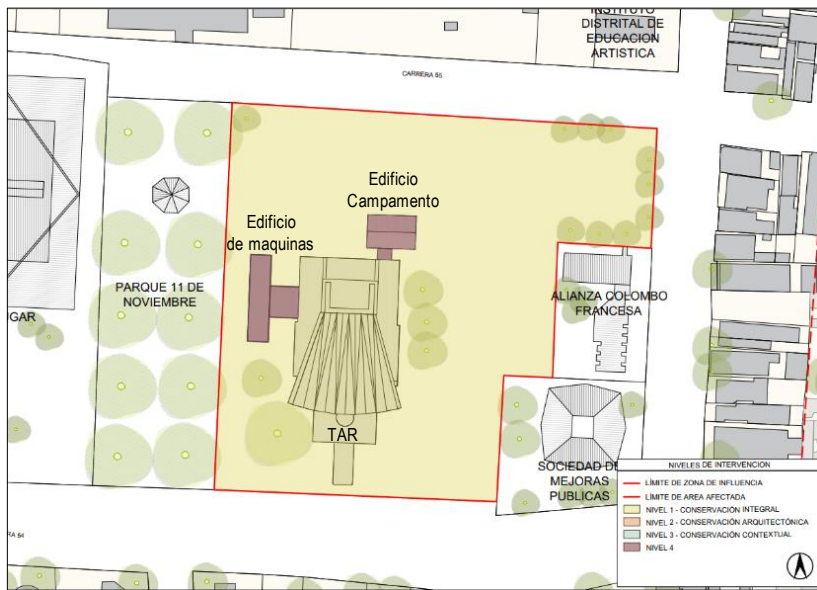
Plano F3 Plano de propuesta de niveles de intervención en el área afectada Fuente: Consorcio NVP
